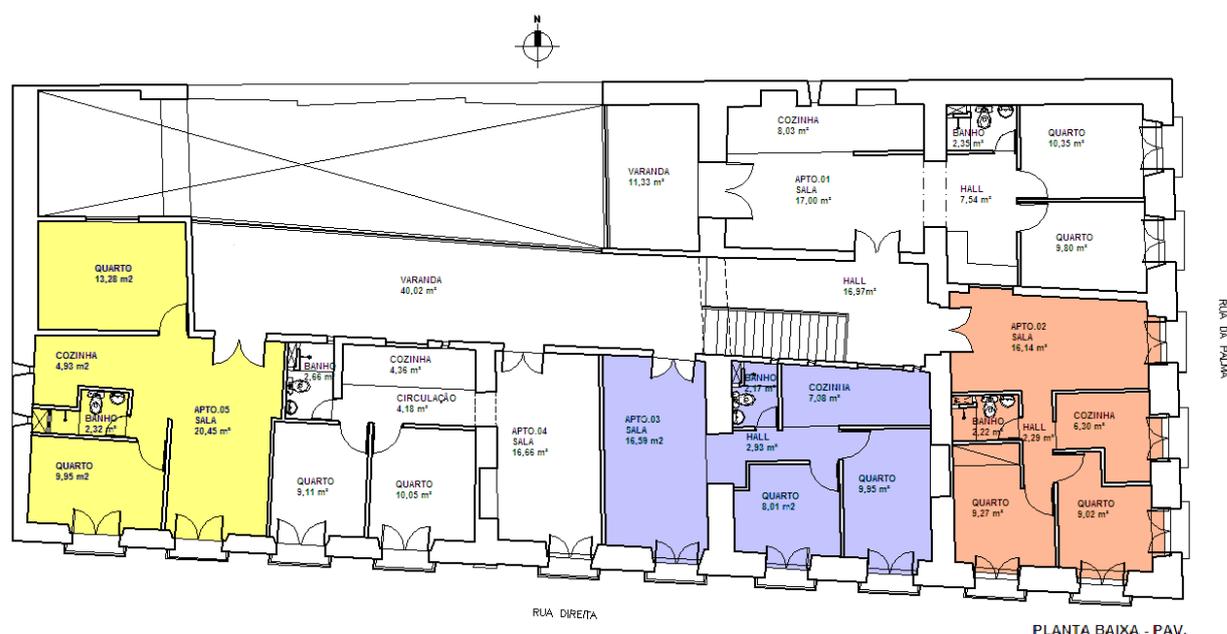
Ilustração de Planta Baixa de Pavimento Superior
